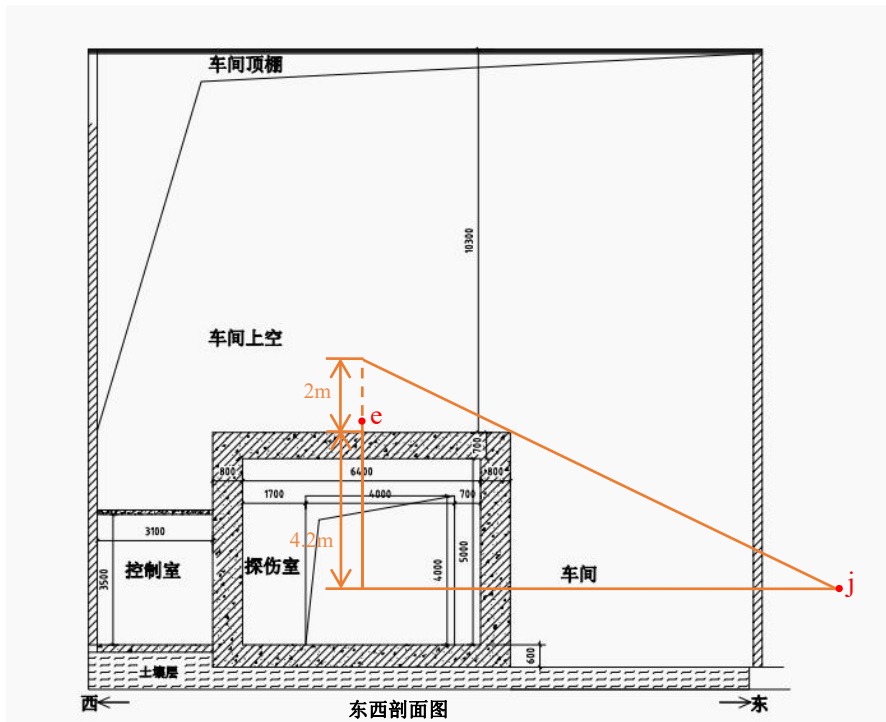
辐射屏蔽计算预测点位图 (e、j 点) (单位: mm)
